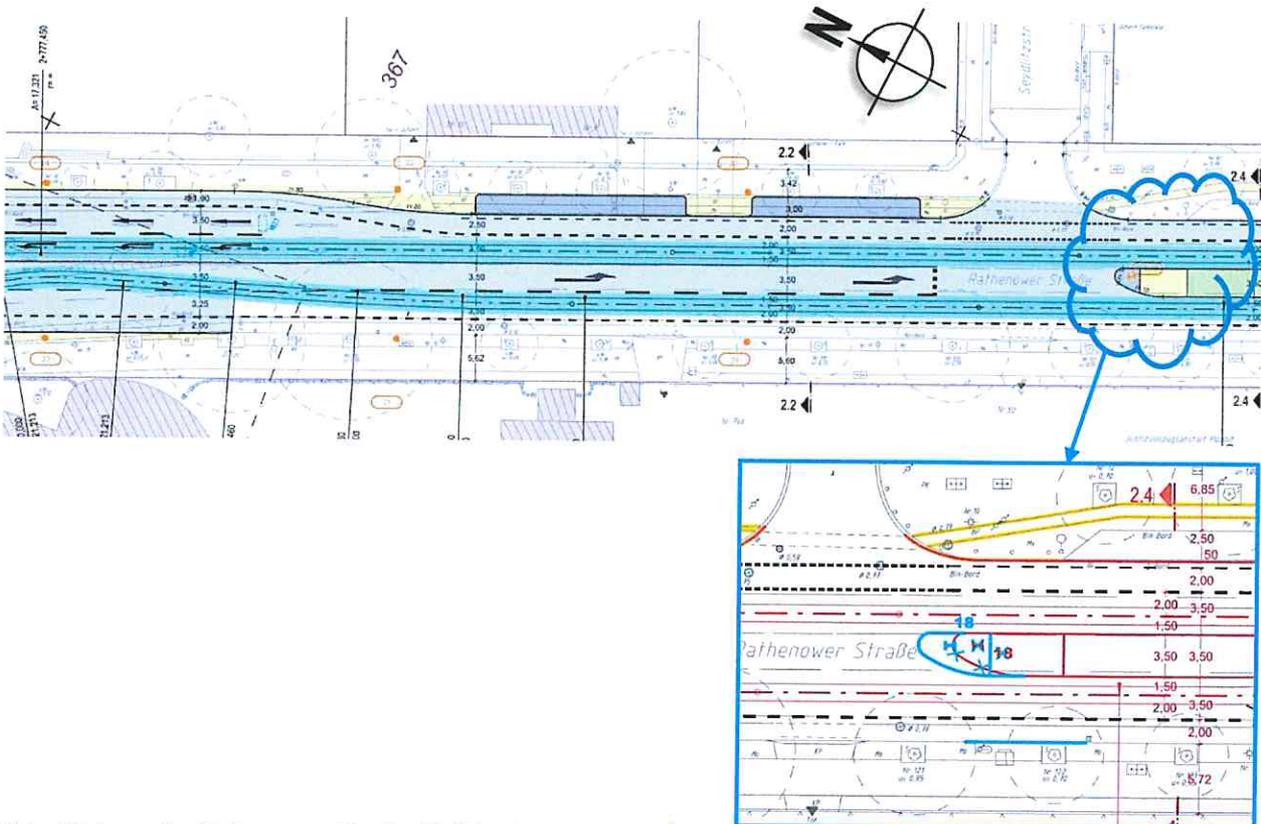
Lageplan Rathenower Straße, Teilabschnitt Nord mit Änderung Mittelinsel Seydlitzstraße
